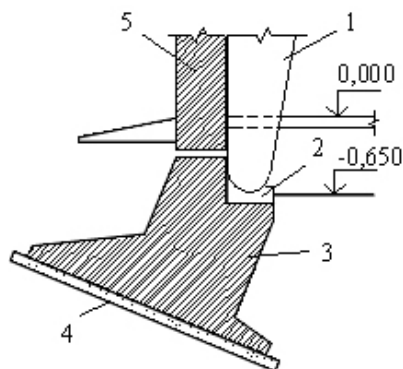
Фундамент с наклонной подошвой: 1 – рама; 2 – подбетонка; 3 – фундамент; 4 – подготовка; 5 – стеновая панель
